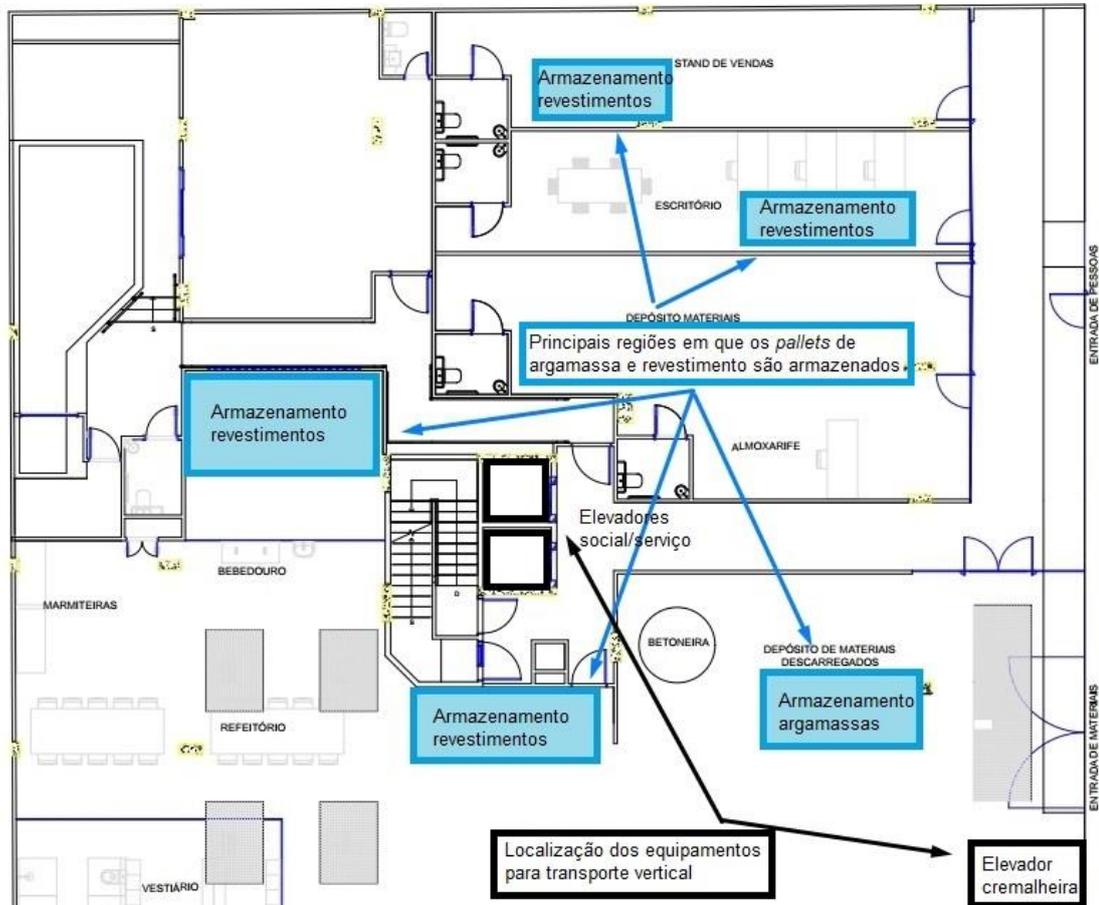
Localização do elevador cremalheira e do elevador de serviços no canteiro de obras.
